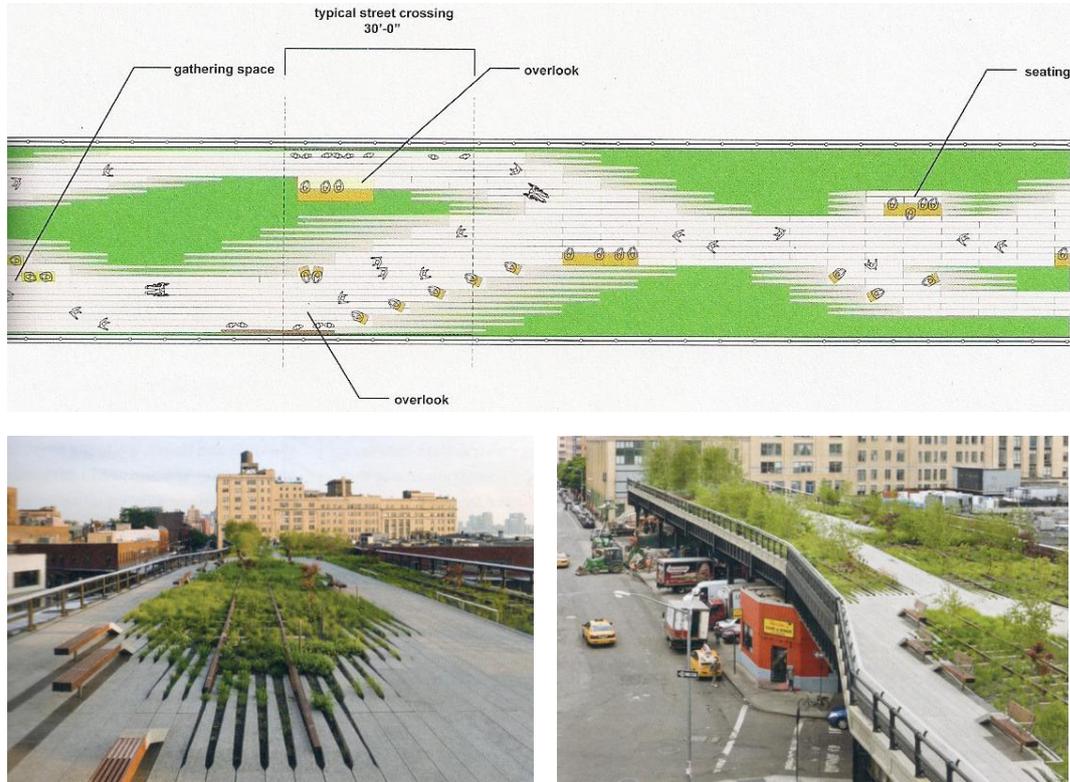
(acima) – Esquema de instalação do piso em placas de concreto; Figuras 20 e 21 - Fotos do piso instalado.<sup>52</sup>
